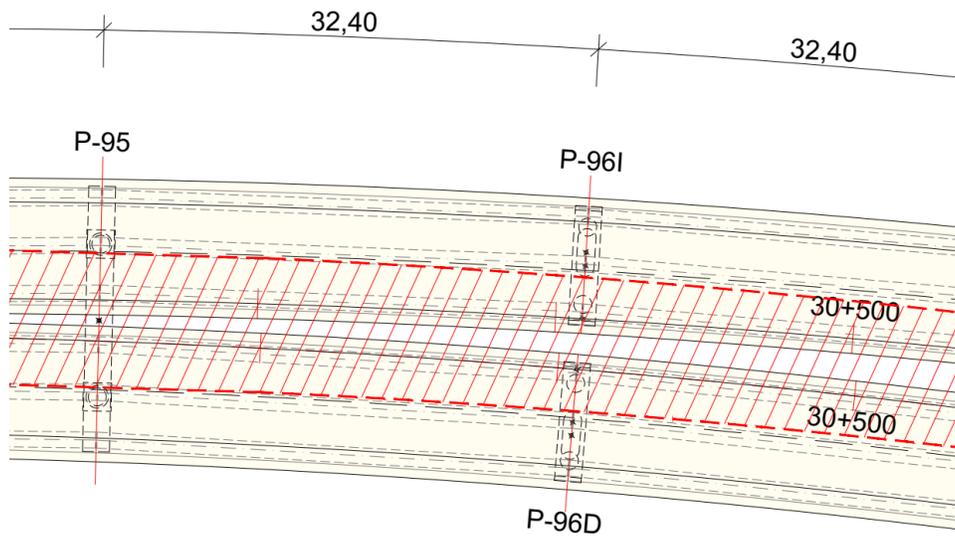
Vista en planta, Bifurcación de viaducto por sobre tren ligero. PK 30+500
